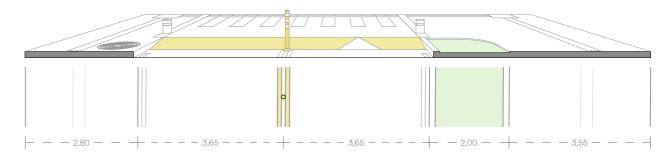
Sección C-C: Propuesta para la Av. Cristóbal Colón.
